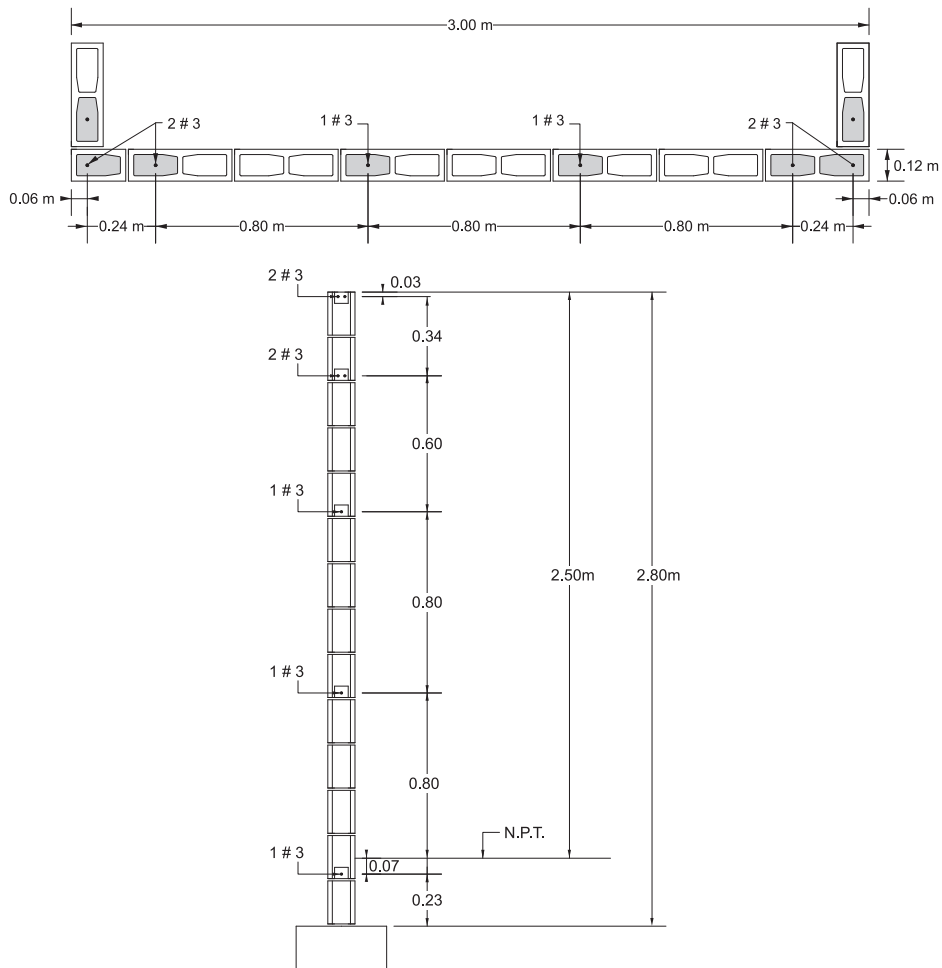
Detalle de pared para cálculo de cuantía de acero.
